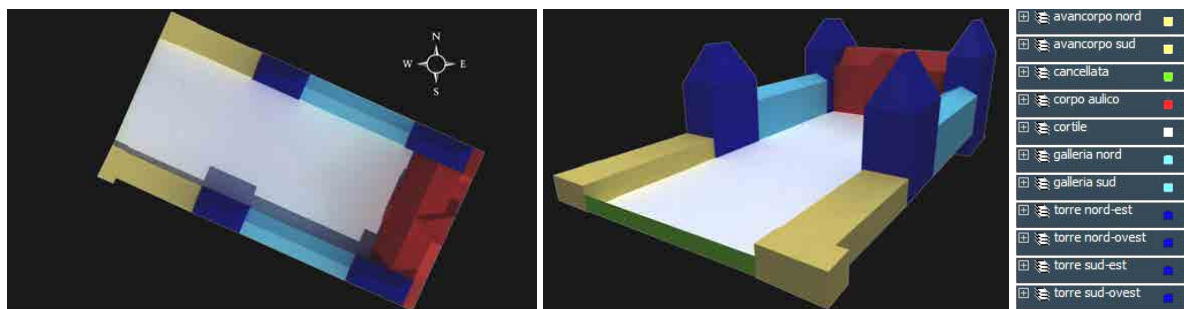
planimetria del complesso e vista prospettica con l'evidenziazione delle diverse unità volumetriche componenti (LOD2).
